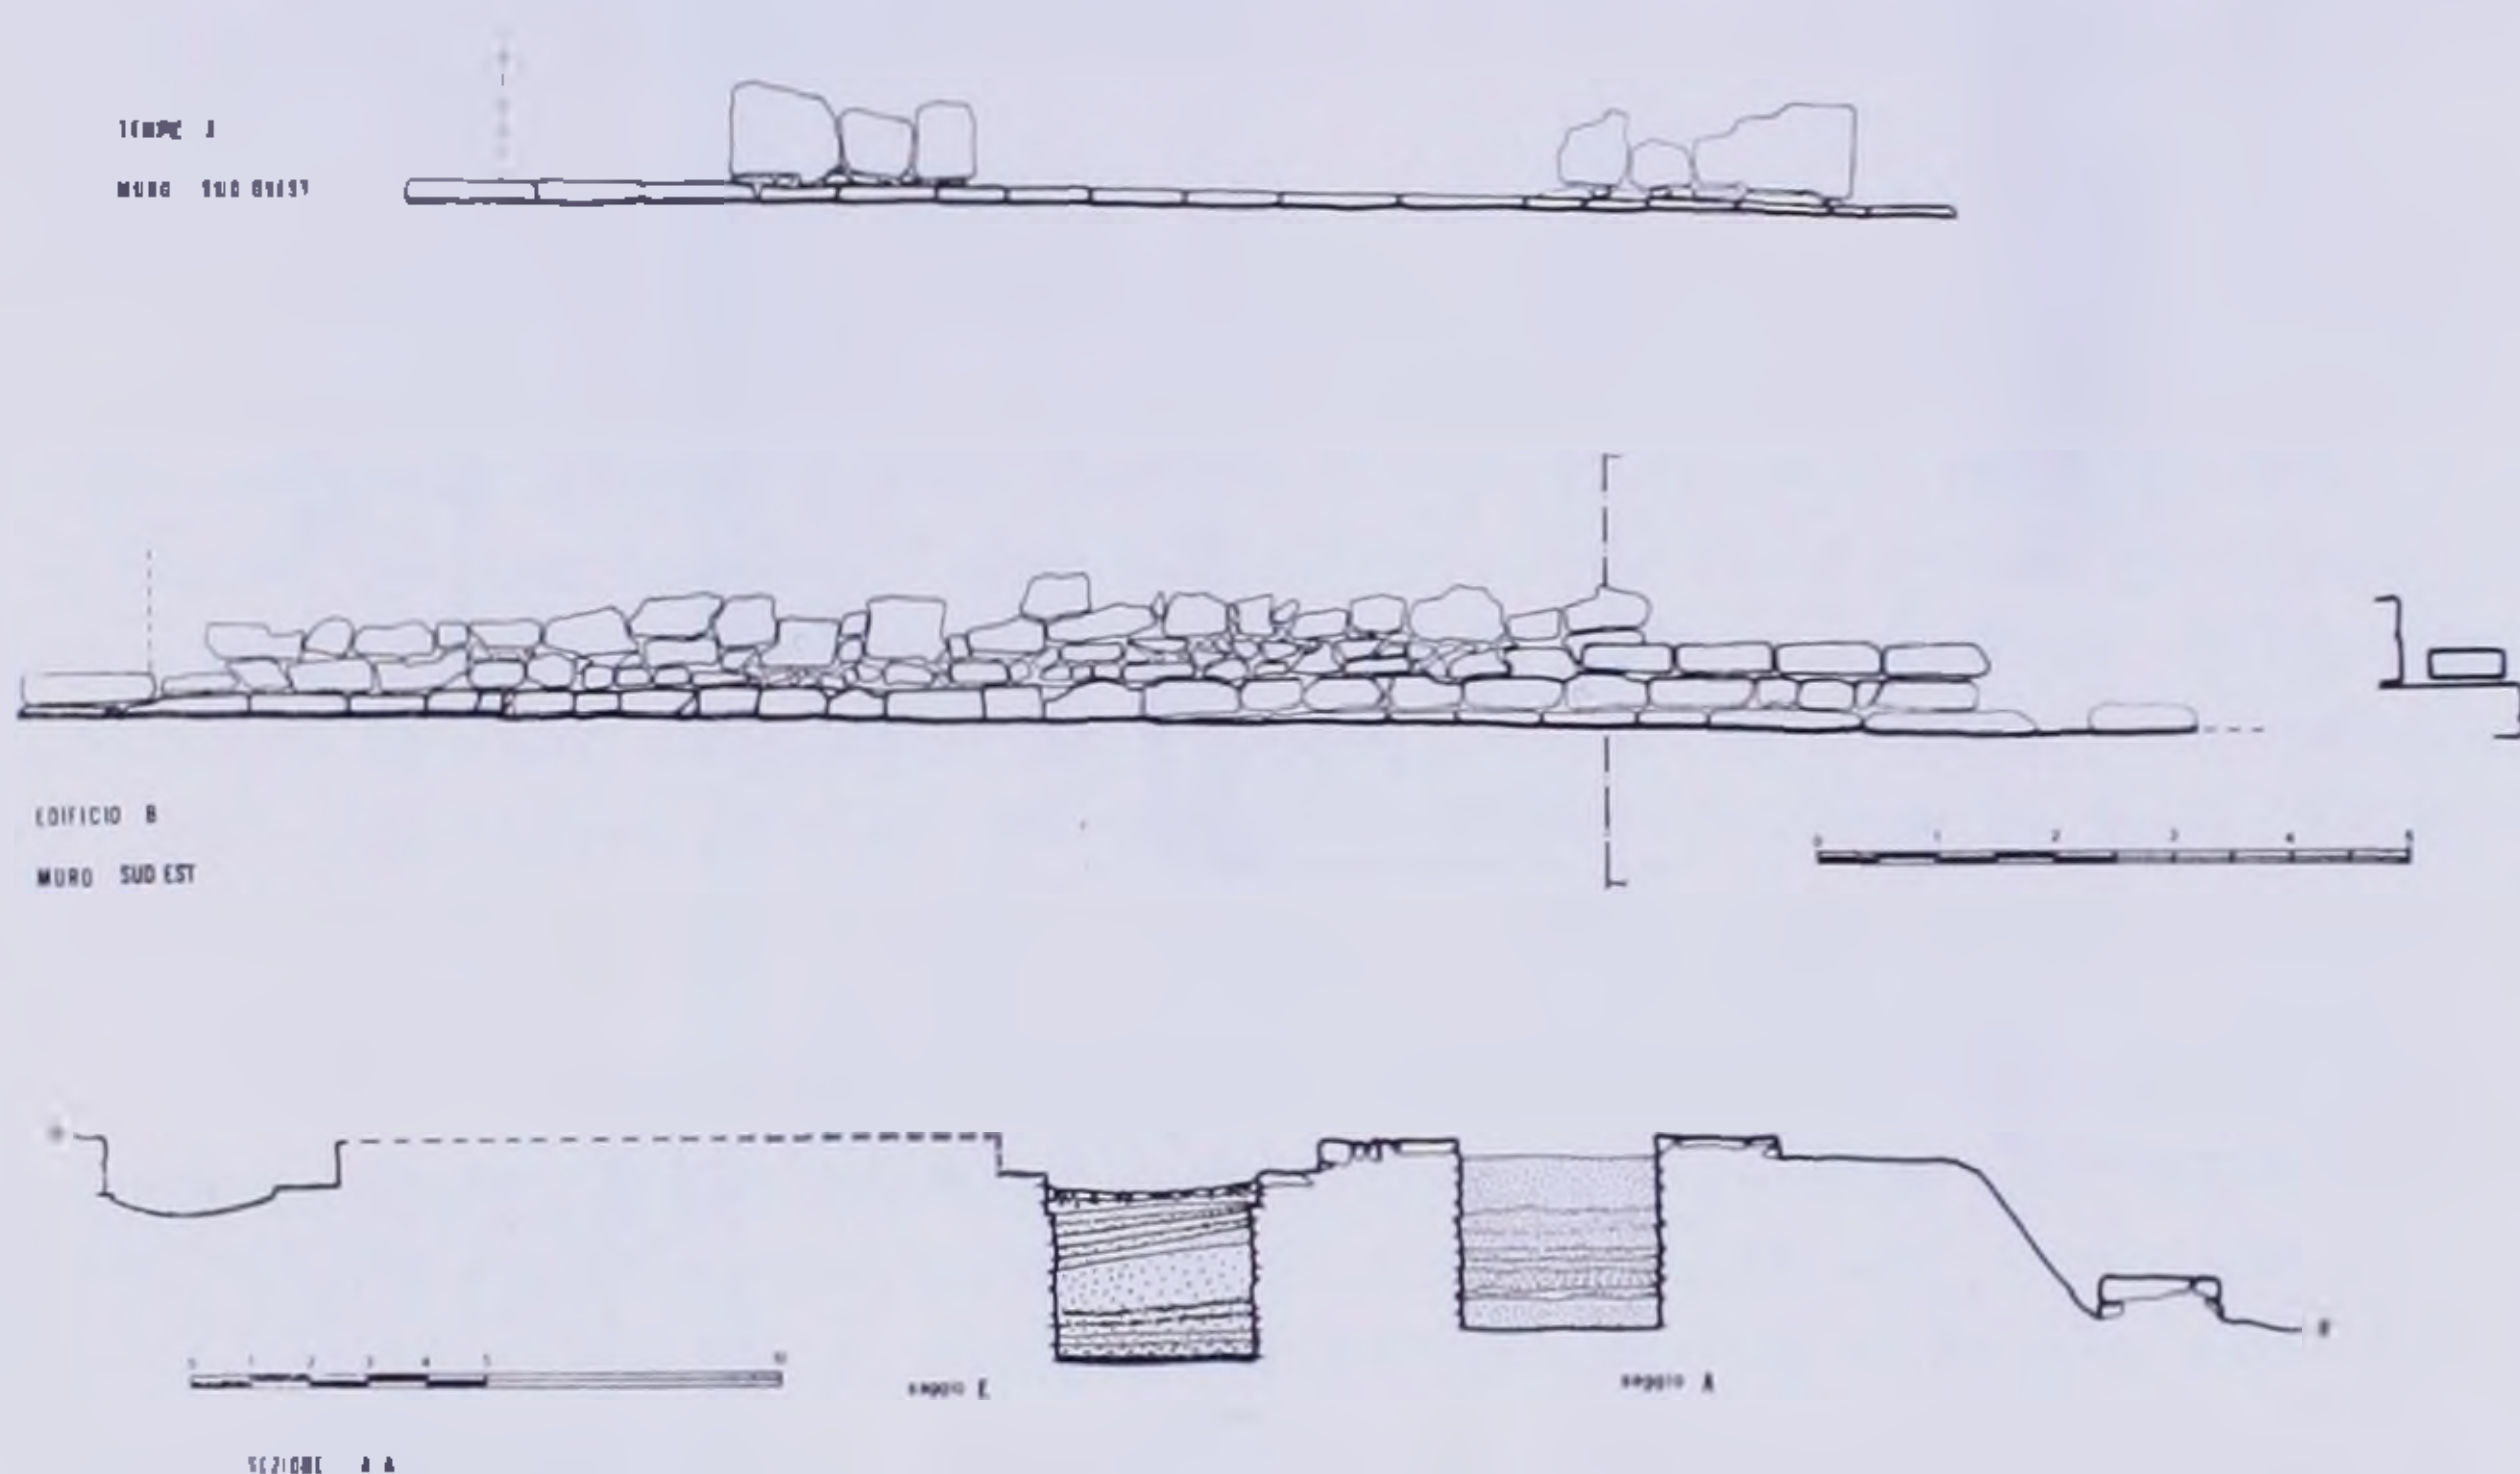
Prospetto dei muri SO del tempio A e SE dell'edificio B. In basso, sezione generale dello scavo (AA' nella pianta a fig. 3).
